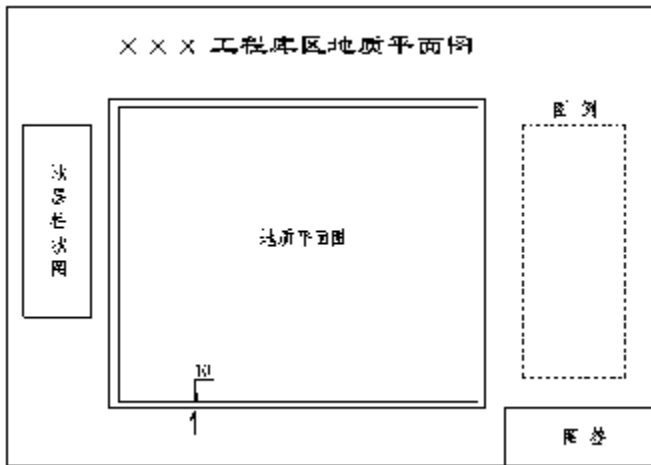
平面图布局及尺寸图示 (单位: mm)
